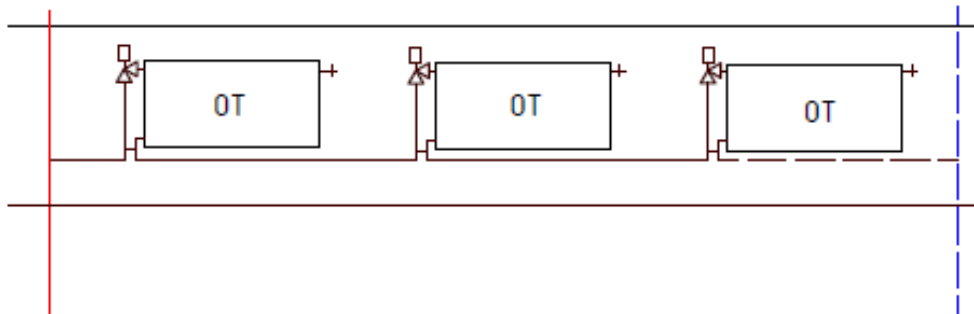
Jednotrubková soustava s obtoky otopných těles – jezdecké napojení
